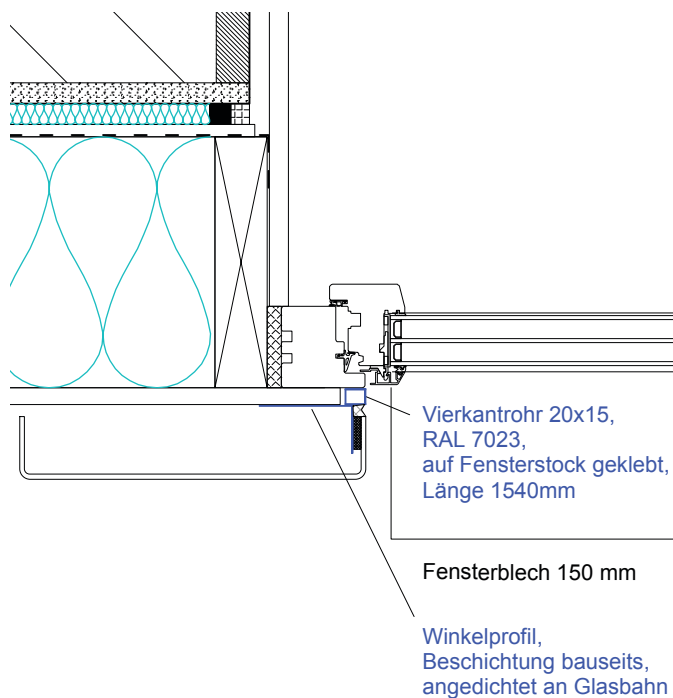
Horizontaldetail Fenster (Zeichnung: BAUFRTZ)
